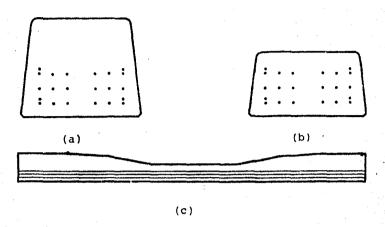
Durmientes de concreto presforzado para ferrocarril, mostrando la posición del refuerzo.
